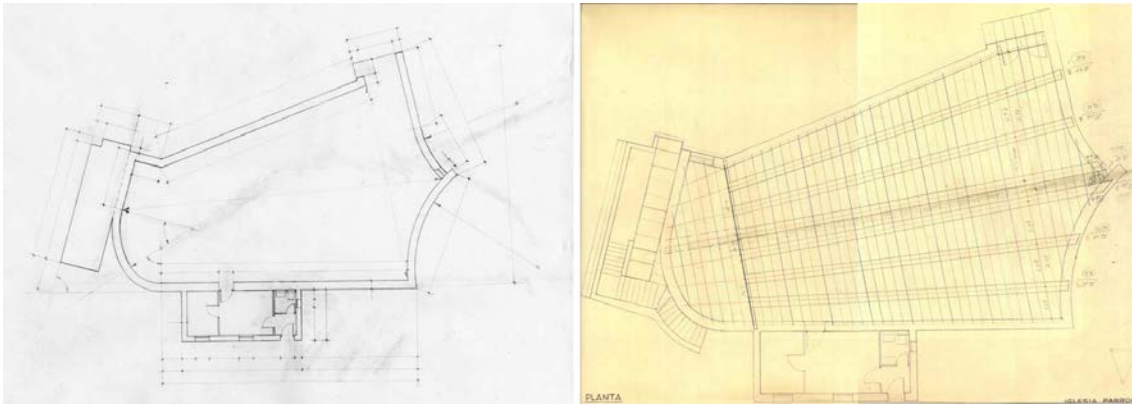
Plano de Nazario Ballesteros con el replanteo de la iglesia ya adaptado a la realidad construida, la puerta de la sacristía que reproduce a la original será eliminada durante el proceso de obra. A la derecha, planta de cubierta con el trazado de las vigas de cubierta marcado con líneas rojas.
